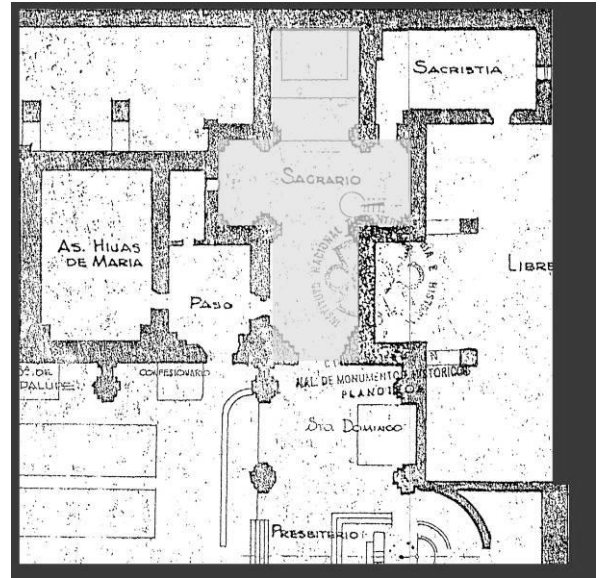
Planta cruciforme de la Capilla del Rosario (Sagrario). Detalle de la planta arquitectónica.³⁵⁸
